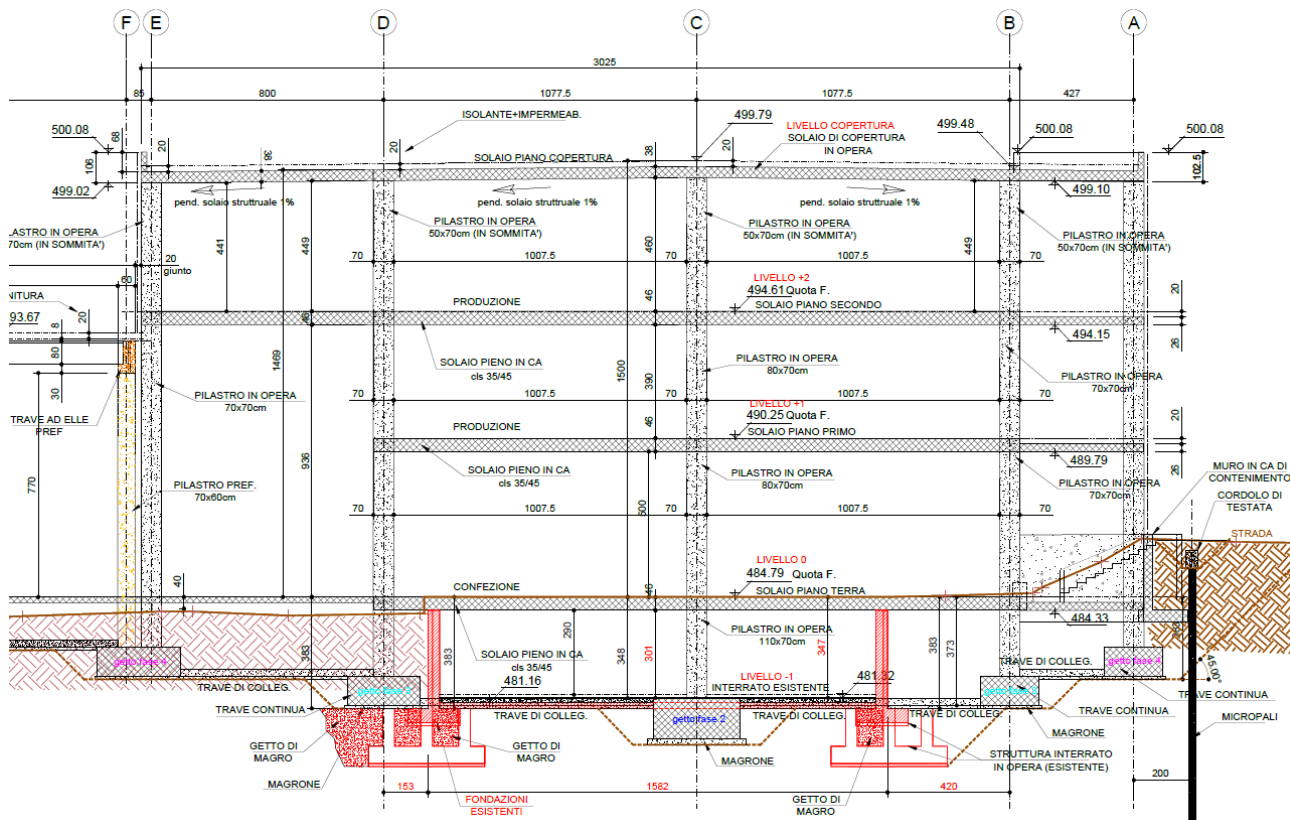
Sezione trasversale D-D – Fabbricato Ex. Piemonte
